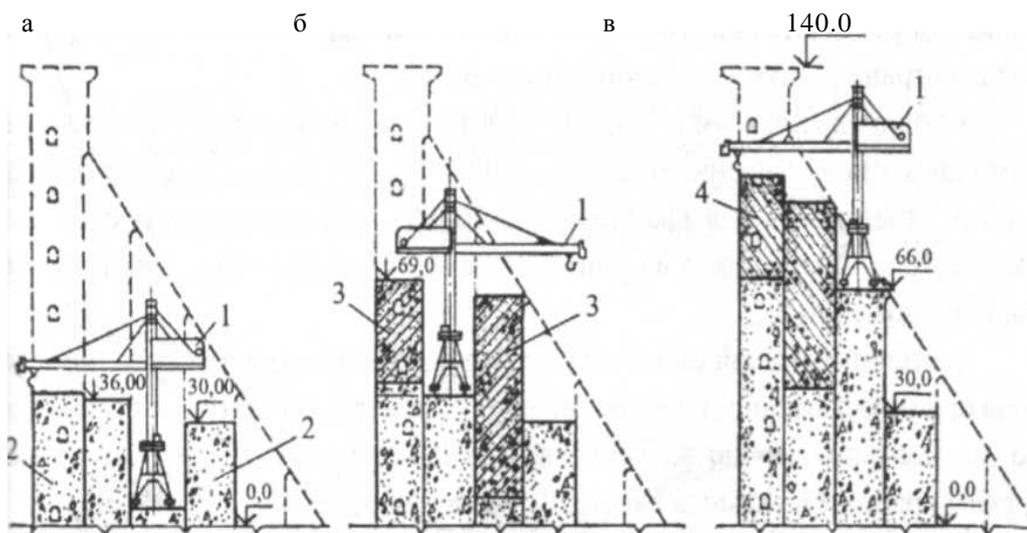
Схема бетонирования плотин самоподъемными кранами без эстакад а,б,в – этапы бетонирования сооружения; 1 кран КБГС-1000; 2,3,4 – блоки бетониреваемые соответственно на первом, втором и третьем этапе
